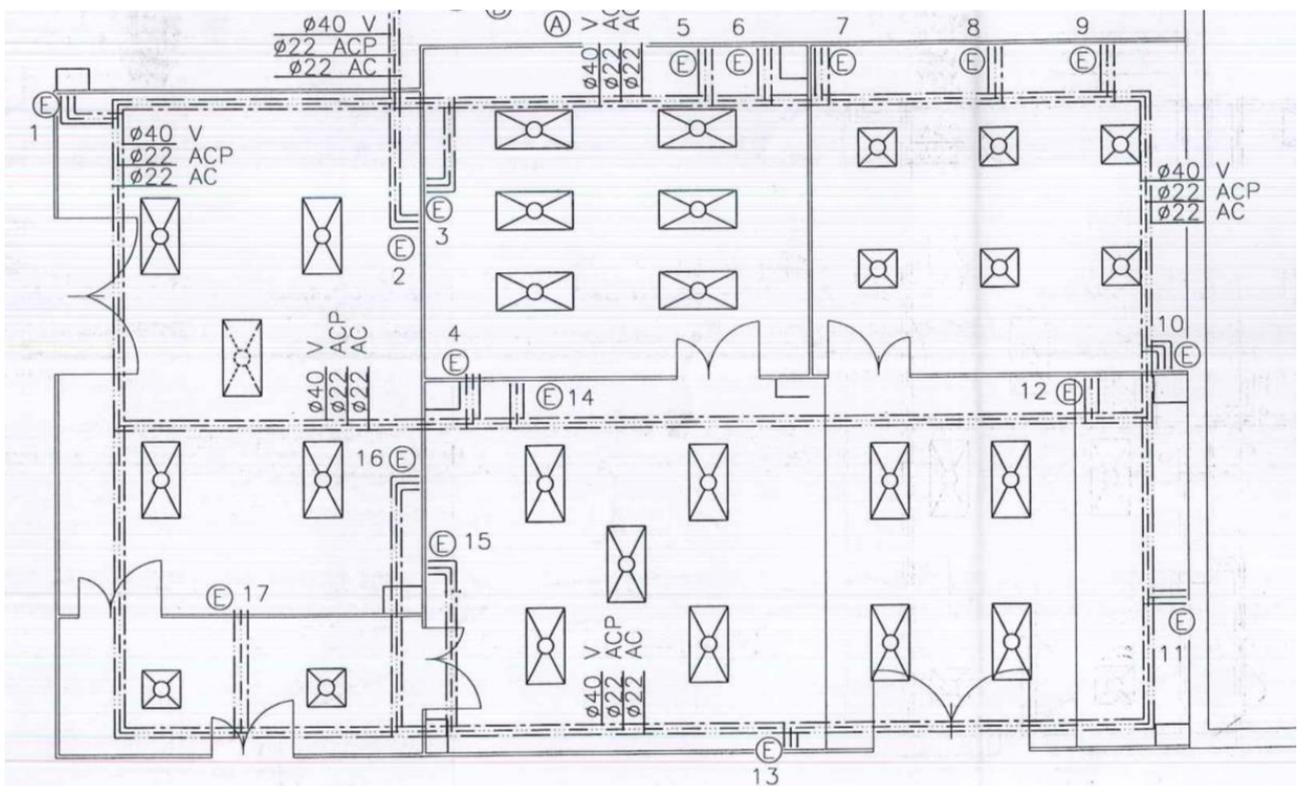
Planimetria della camera bianca della Sezione di Firenze.
